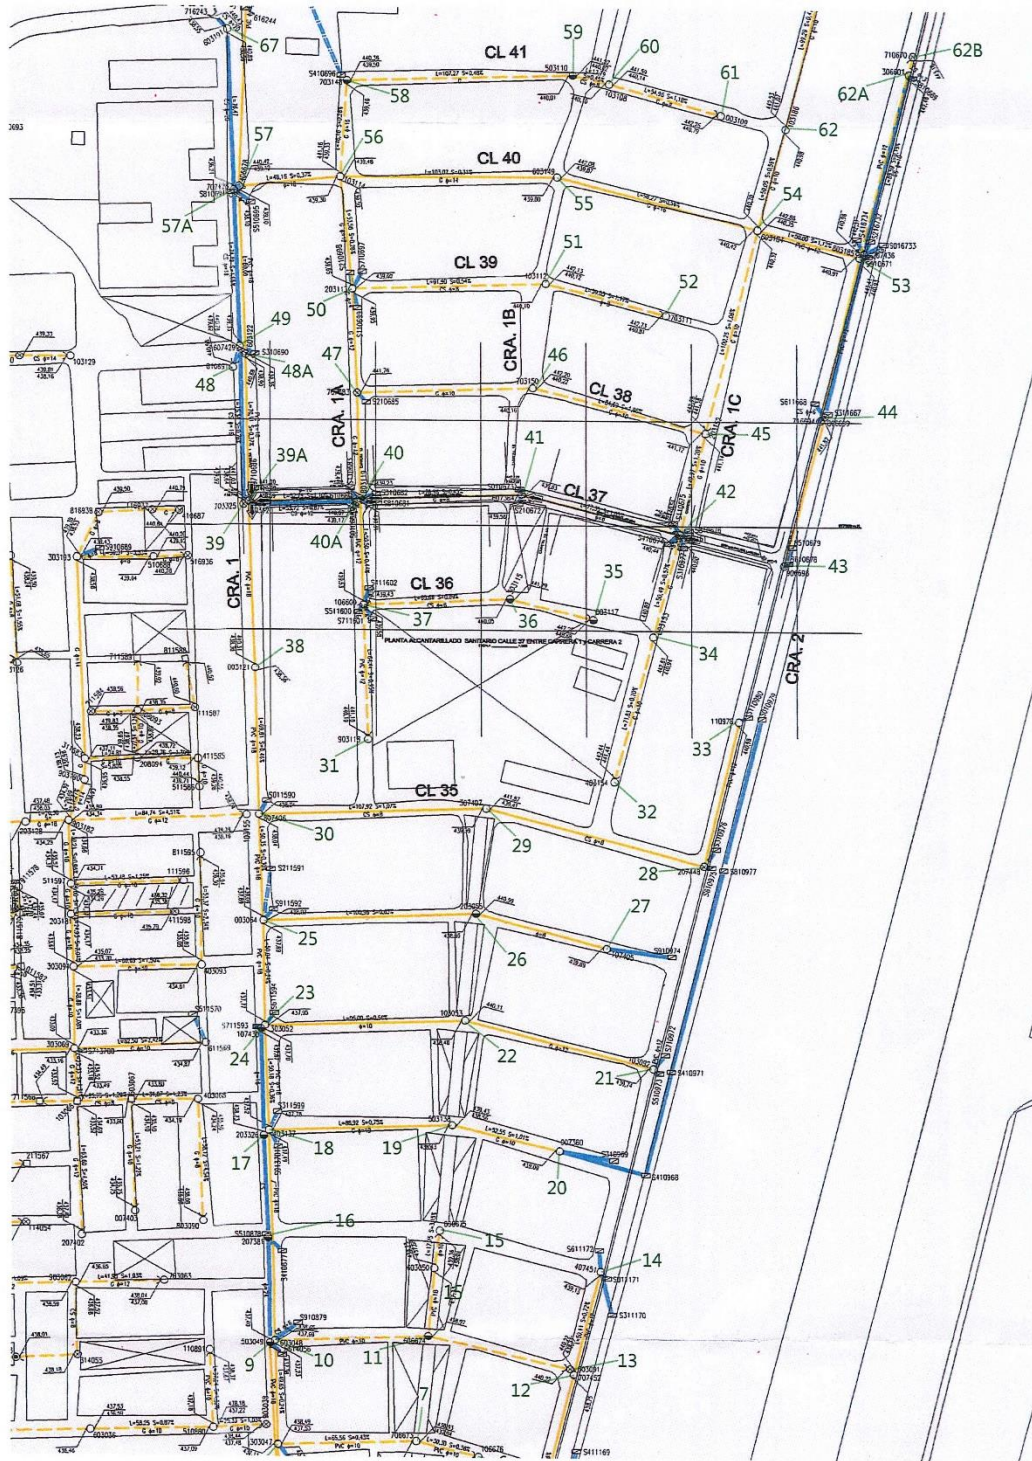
Plano de la red de alcantarillado del barrio Cándido suministrado por Las Ceibas ESP
